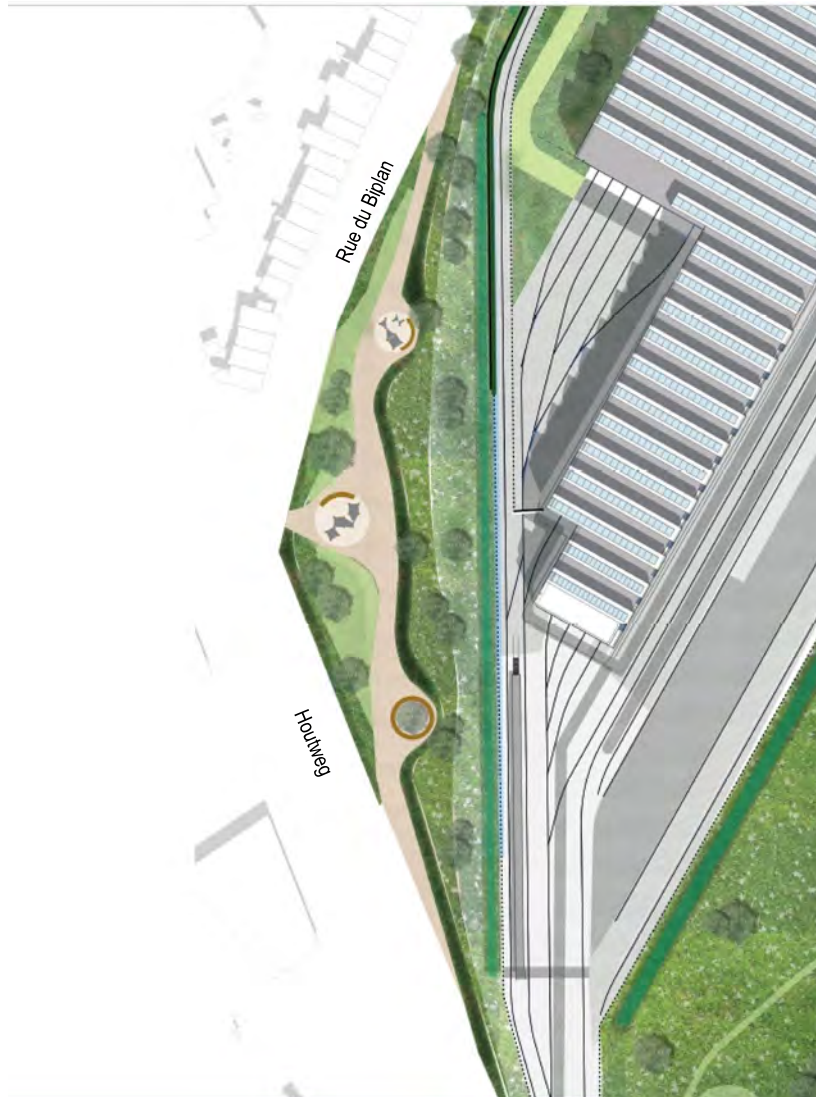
Vue sur la zone de parc public au croisement de la rue du Biplan et de Houtweg (BMN, 2018)
